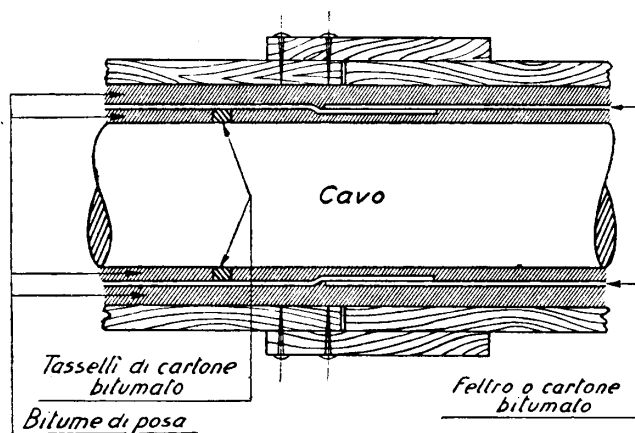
Cassetta tipo « Panara »; pianta con sistema di giunzione.
